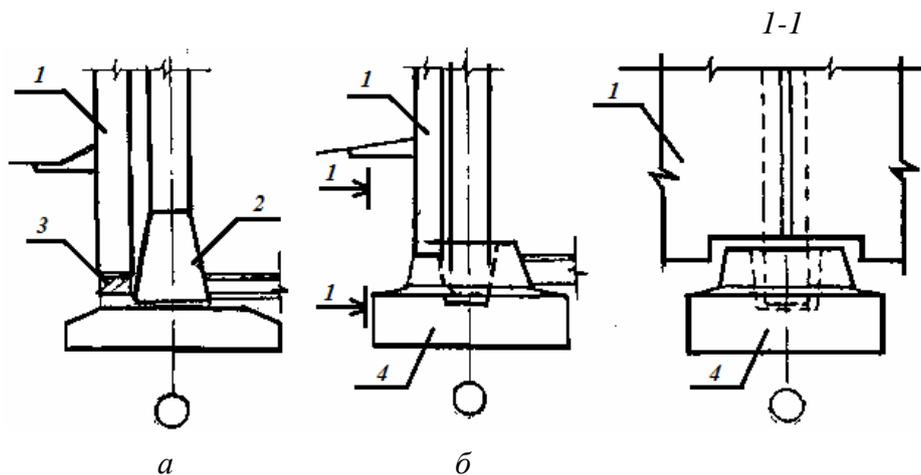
Конструкции сборных панельных фундаментов: *a* — конструкция на фундаментной подушке; *б* — конструкция фундамента стаканного типа; 1 — наружная цокольная панель; 2 — пирамидальное основание колонны; 3 — фундаментная балка; 4 — фундаментный стакан
